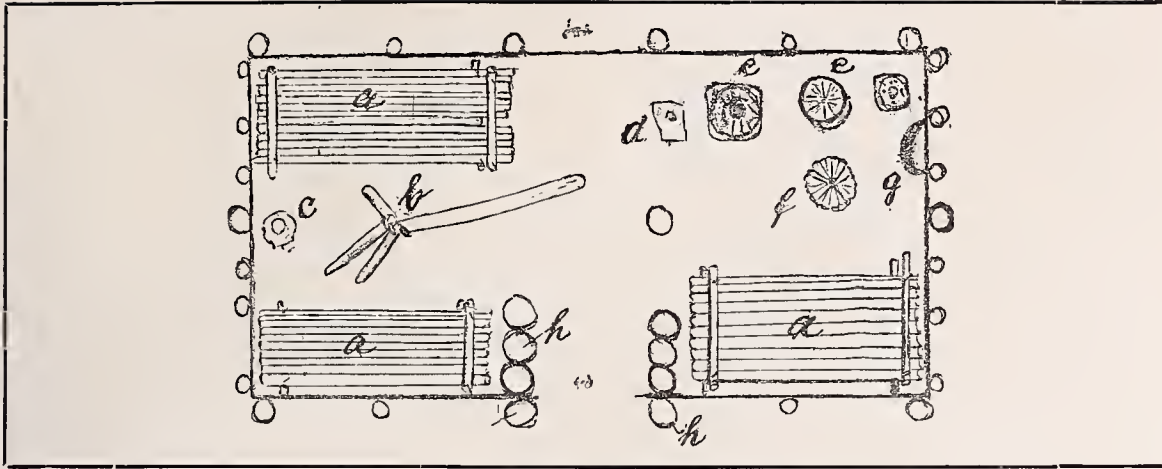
Grundriß eines Wohnhauses der Pangwe.
